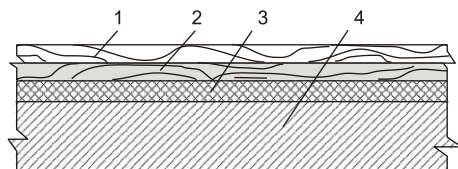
Конструкция пола из сверхтвердых древесно-волоконистых плит по перекрытию из сплошных панелей:
